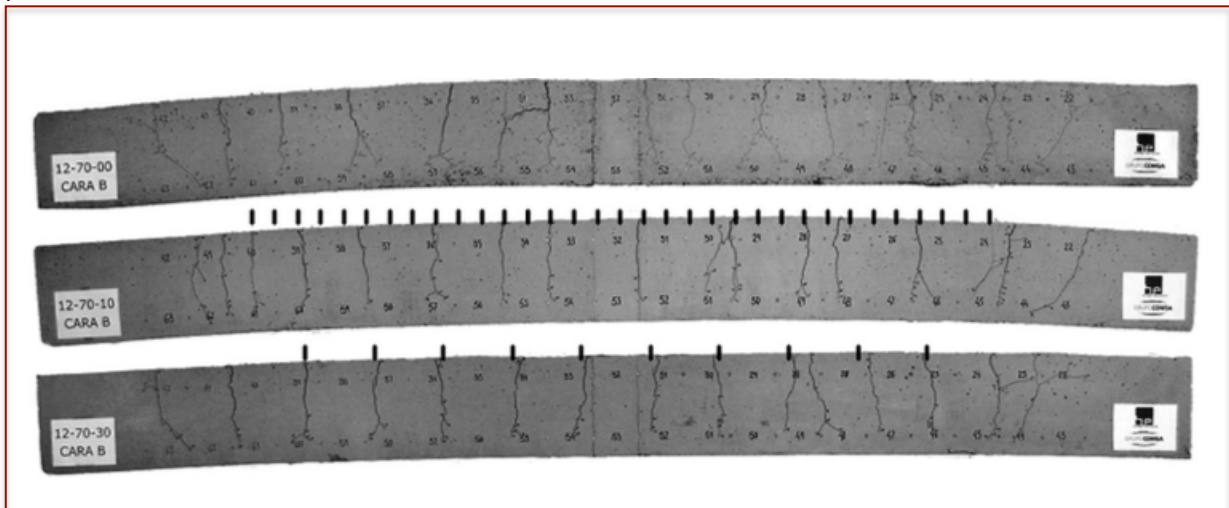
Efeito do espaçamento entre estribos no espaçamento de fendas, em vigas de diâmetros de 12 mm de armadura longitudinal ($c=70$ mm) [7].
